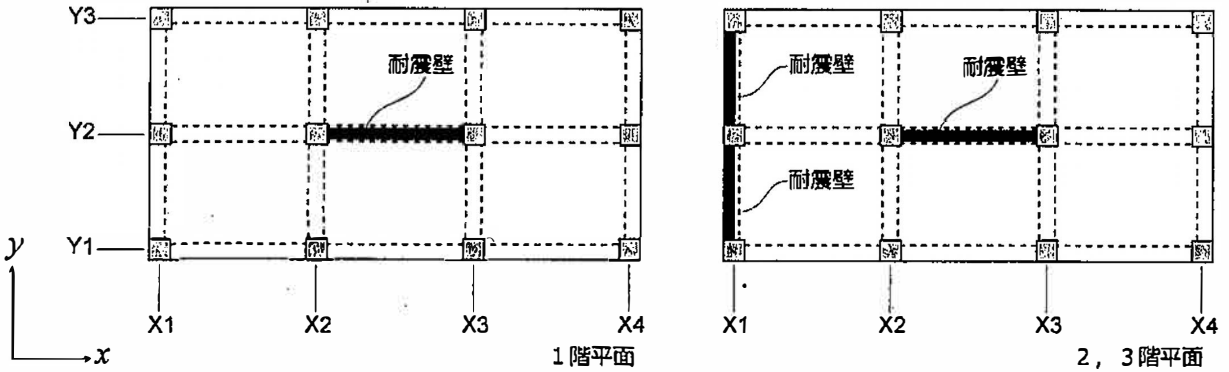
鉄筋コンクリート造架構の平面図（床梁伏図）
